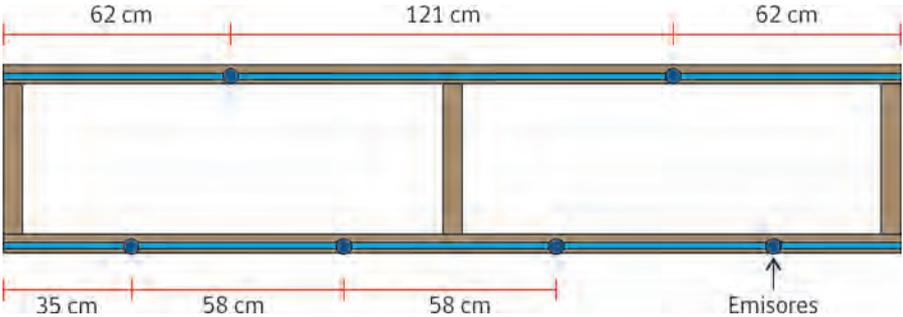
Vista de planta del módulo, indicando la disposición de los emisores.
